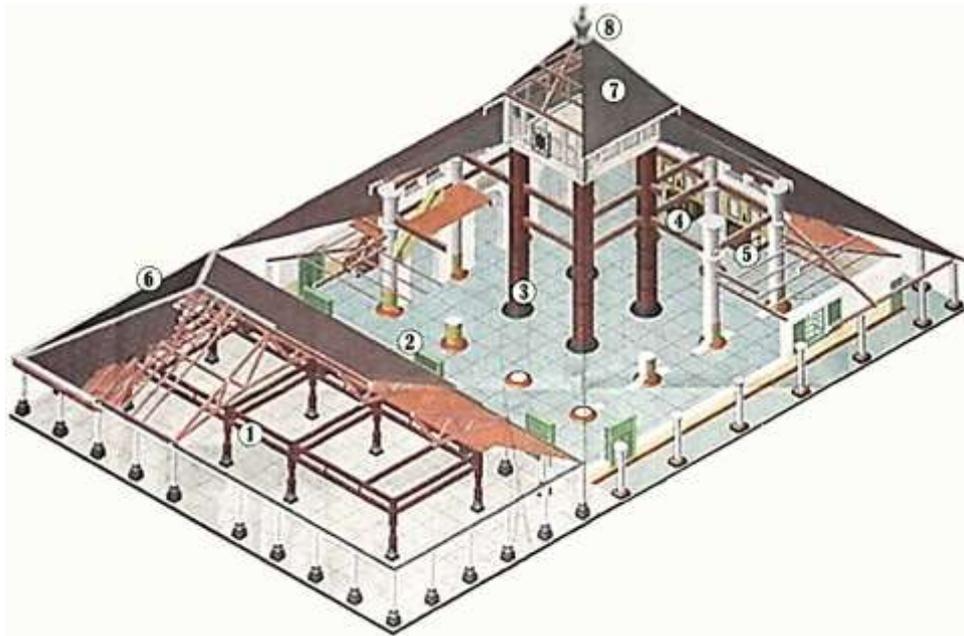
Pondasi Umpak Soko Majapahit
